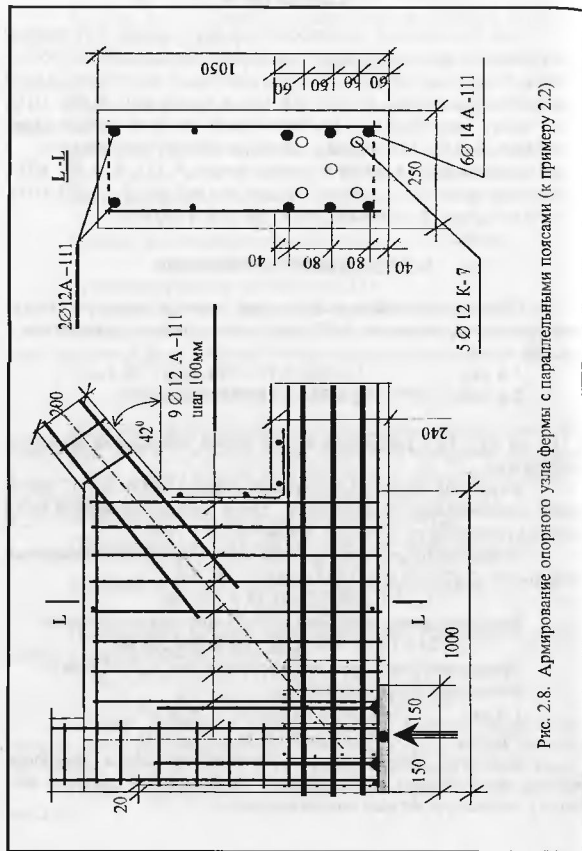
Армирование опорного узла фермы с параллельными поясами (к примеру 2.2)
